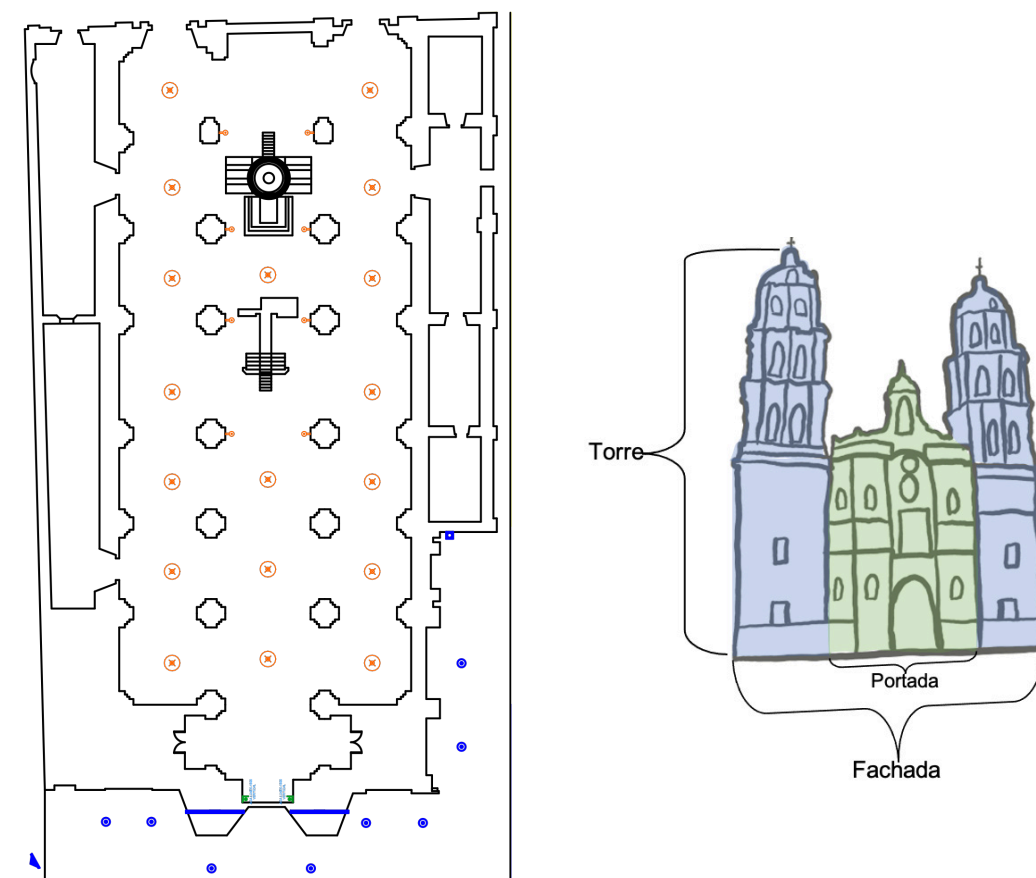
Planta arquitectónica (INAH, 2022) y diagrama de elementos que conforman la fachada principal de la Catedral.
